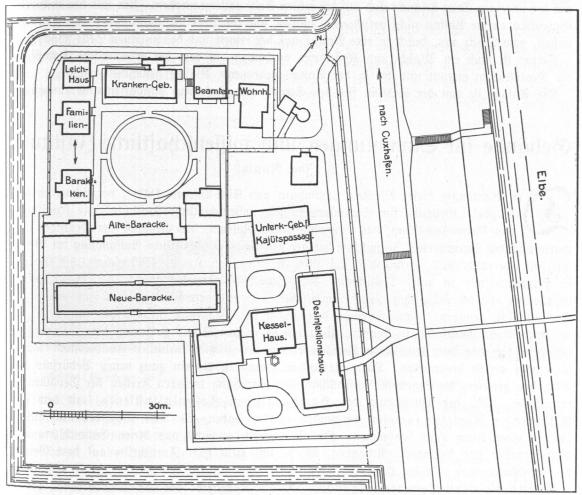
Quarantäneanstalt Groben bei Curhaven, Lageplan.
